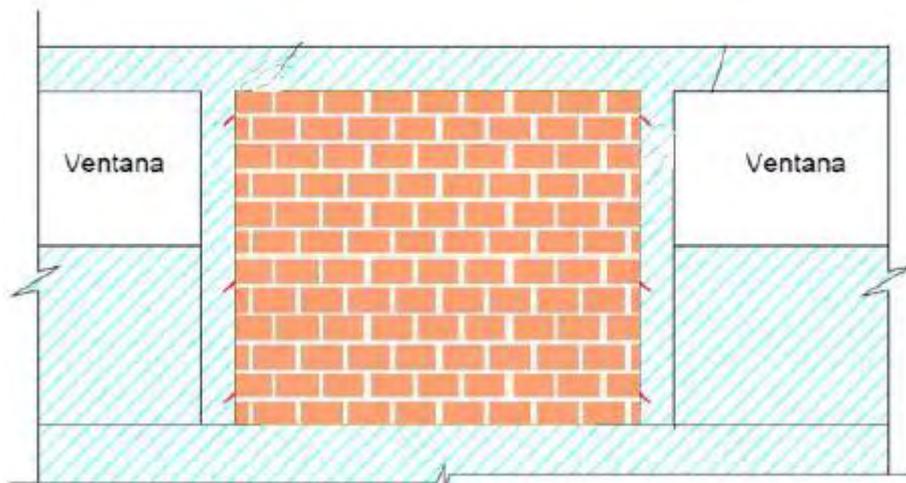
Detalle de elevación del refuerzo con cierre de paños (Fuente: Informe DAI, 2007)
